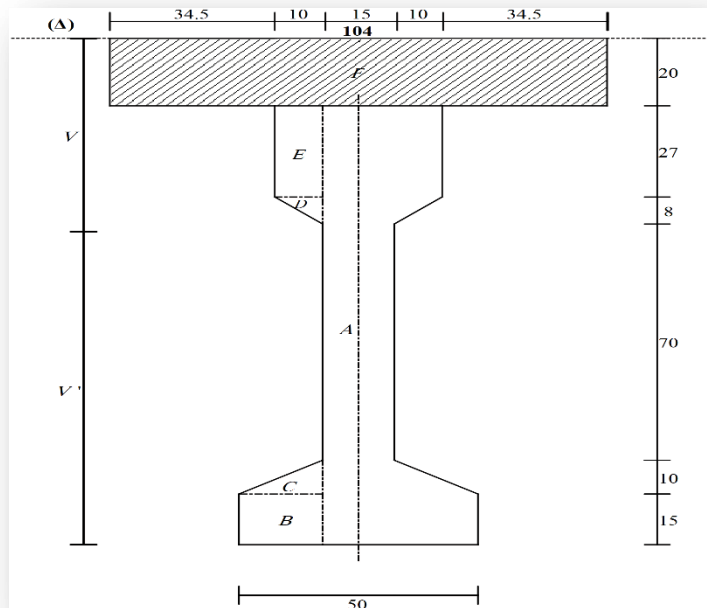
Poutre intermédiaire section médiane avec hourdis.
